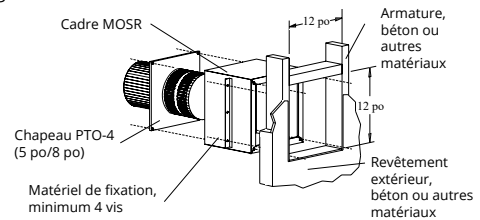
d Installation d'un chapeau PTO avec un cadre MOSR.
